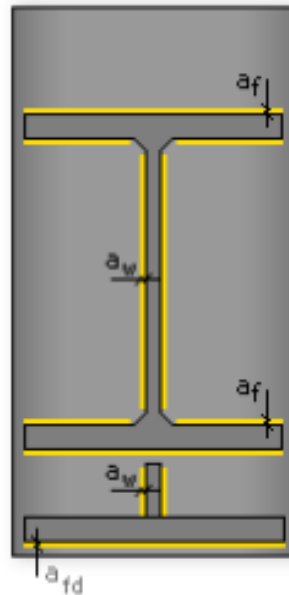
Ligações soldadas presentes na ligação entre duas travessas
